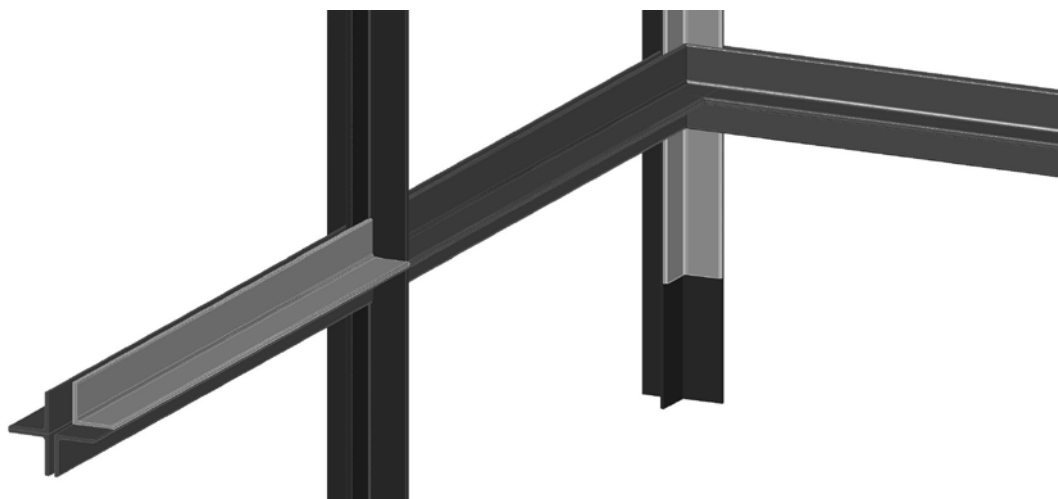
Ligação dos pilares e vigas em forma de cruz grega
